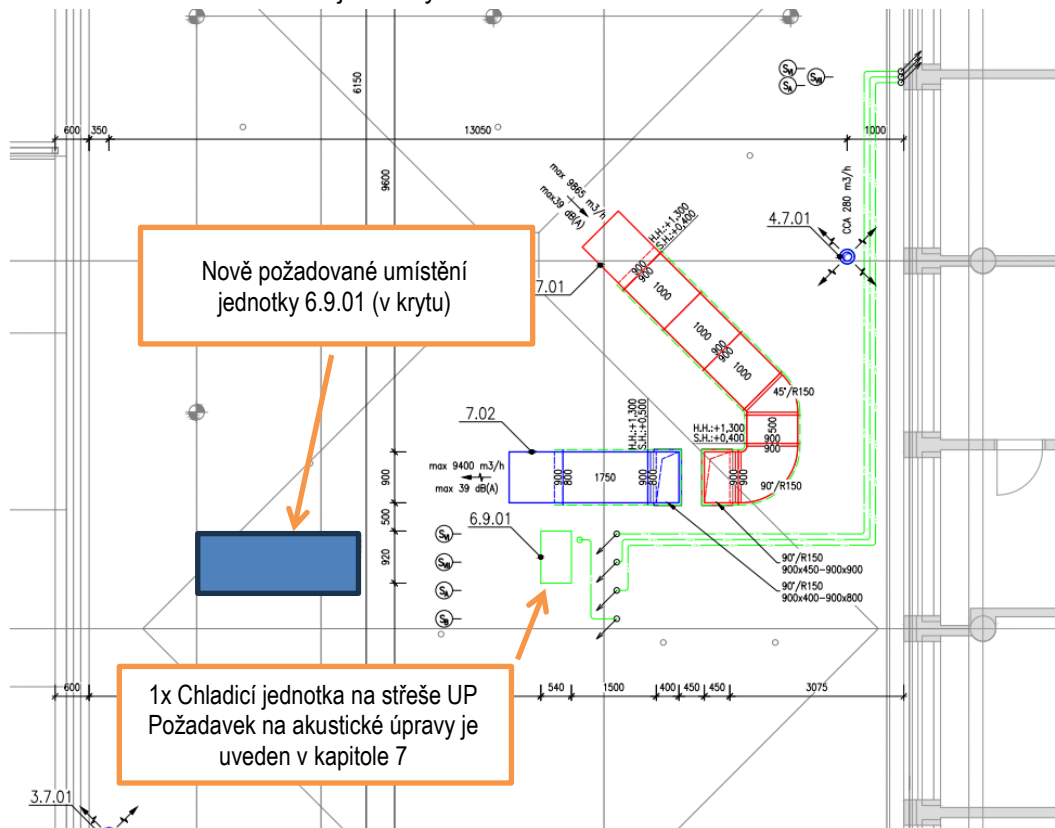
A – Umístění chladicích jednotek na střeše nemocnice – výkres [P05]:
